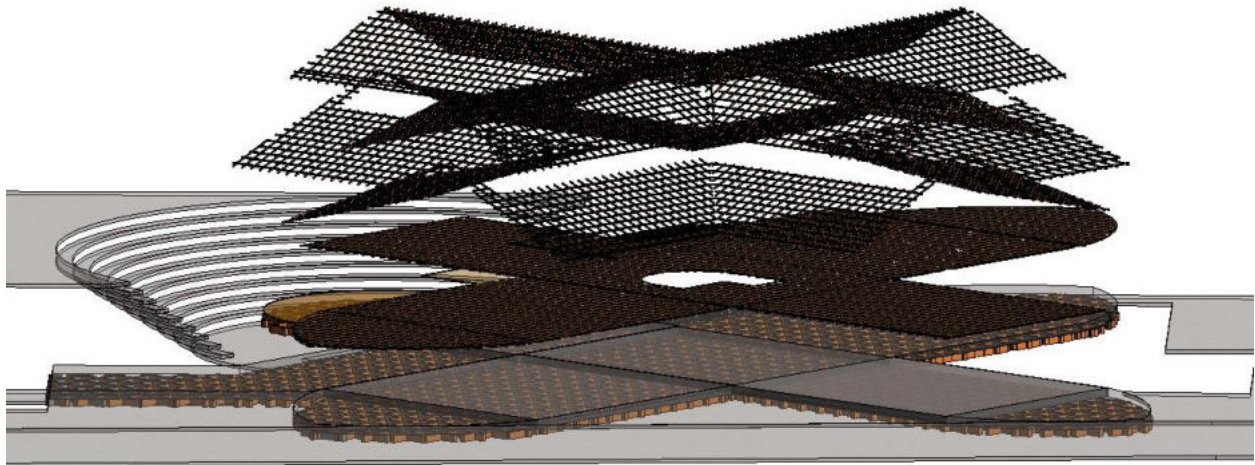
Modelo de estructura de pilotes, losas y cubierta de Bambú (Elaboración propia)
